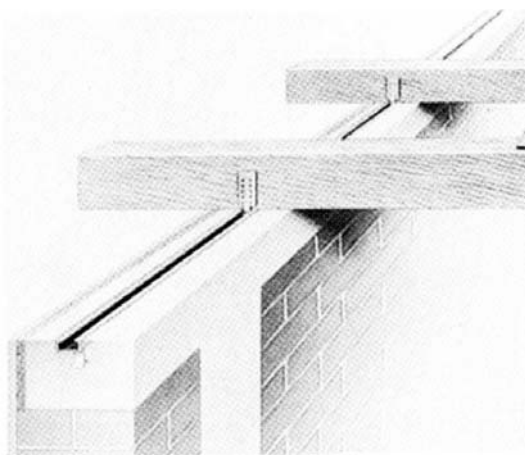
Uniones ajustables Halfen HTA madera-hormigón
